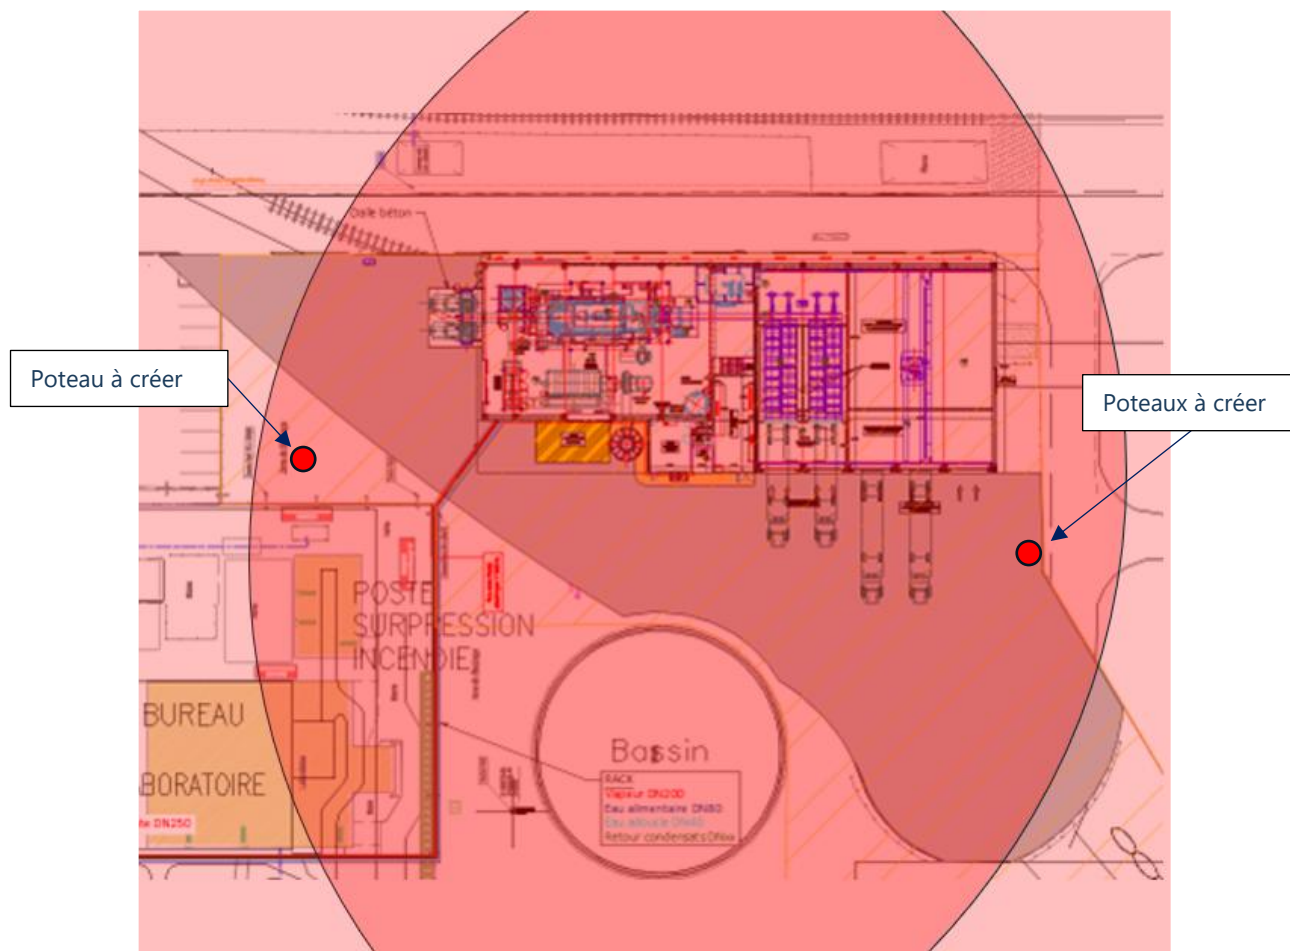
Plan de positionnement de poteaux incendie et zone de rayon de 100m
